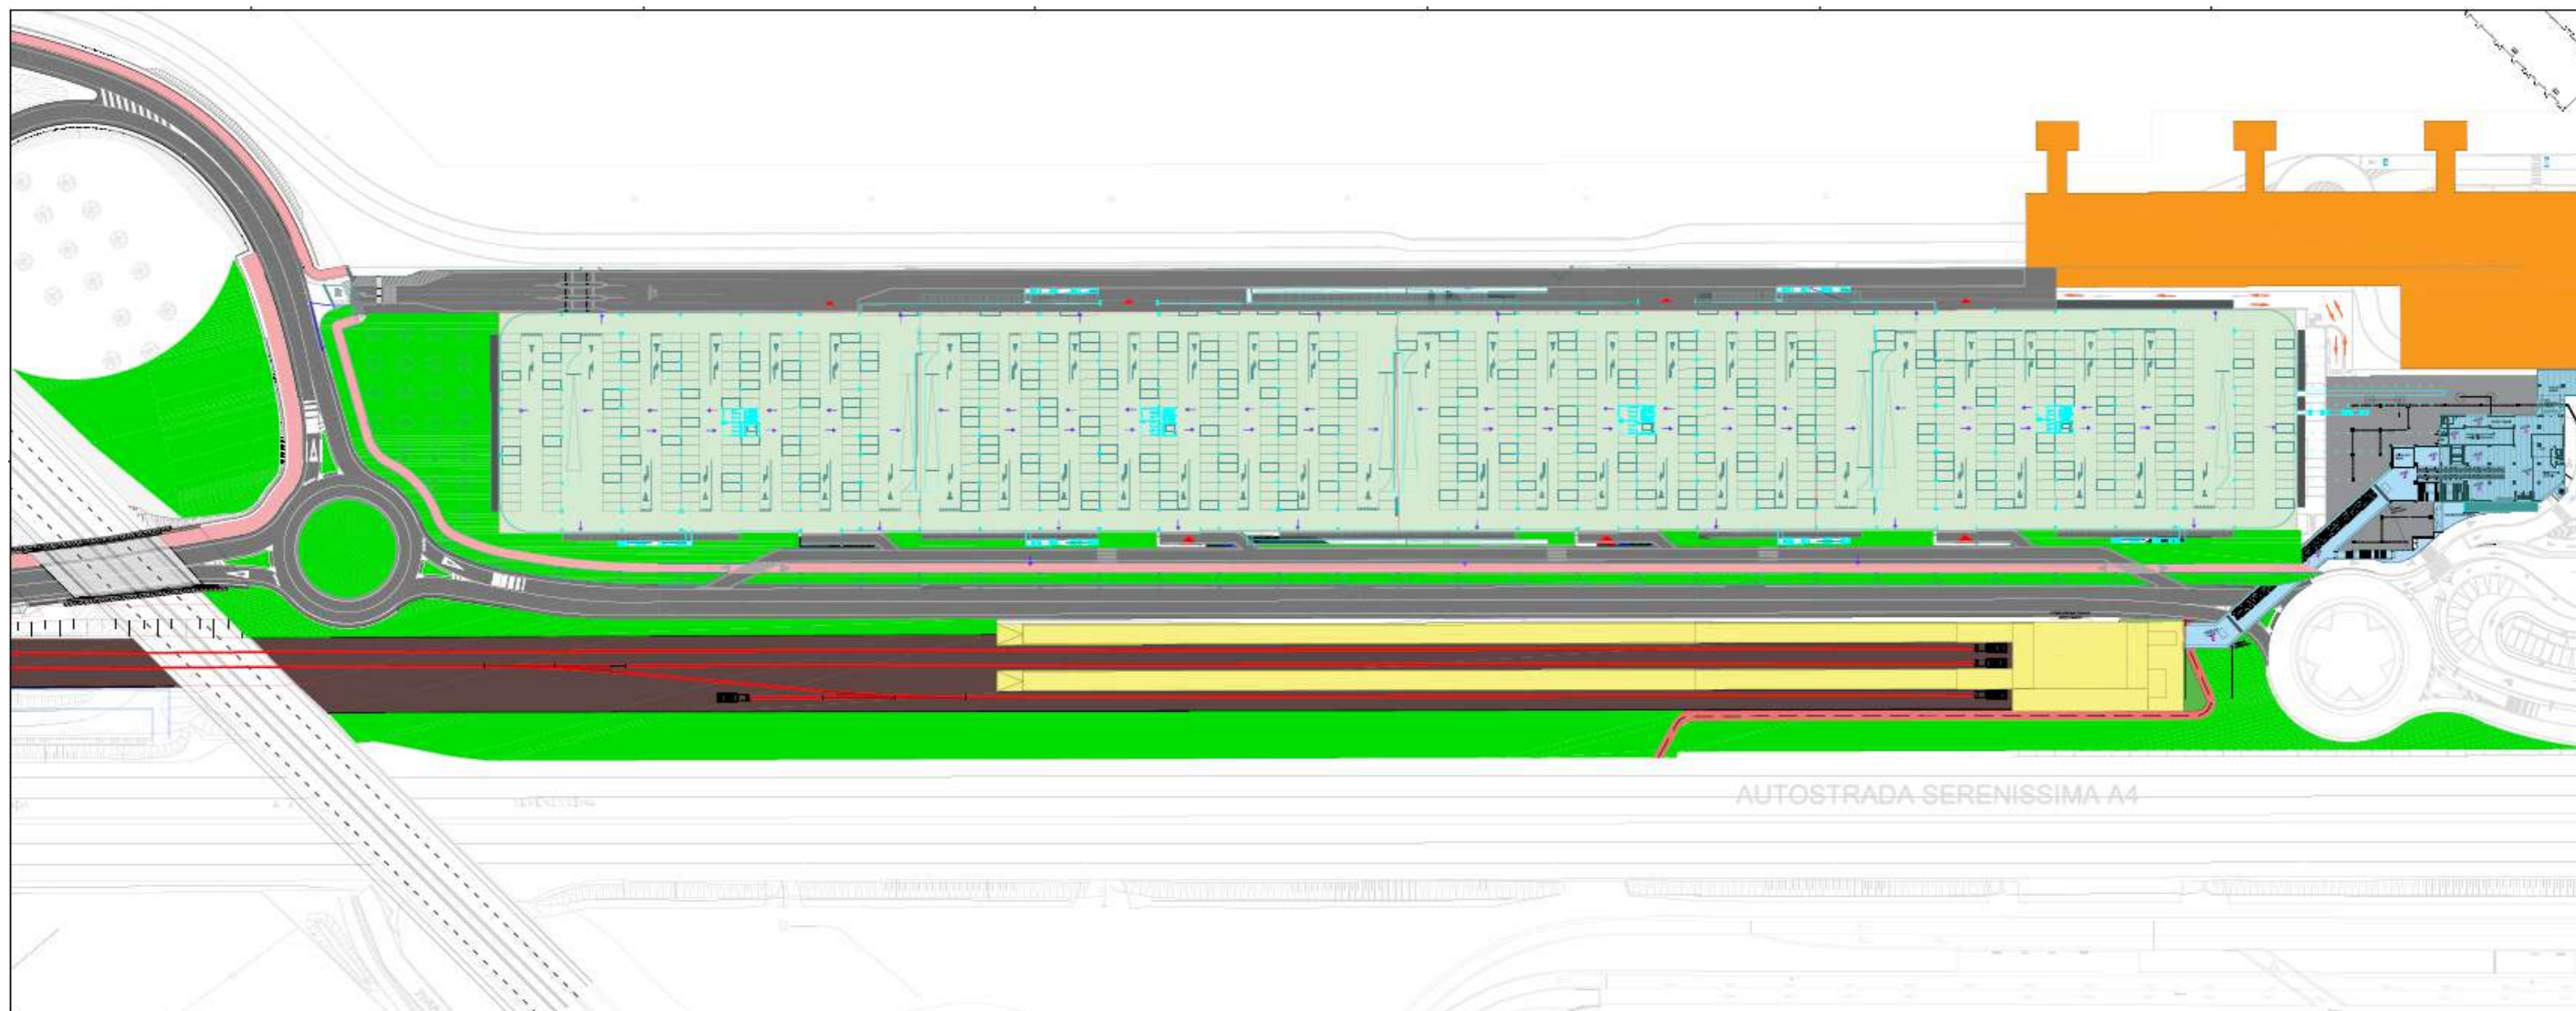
Configurazione di progetto: Assetto delle reti di accessibilità ferroviaria
